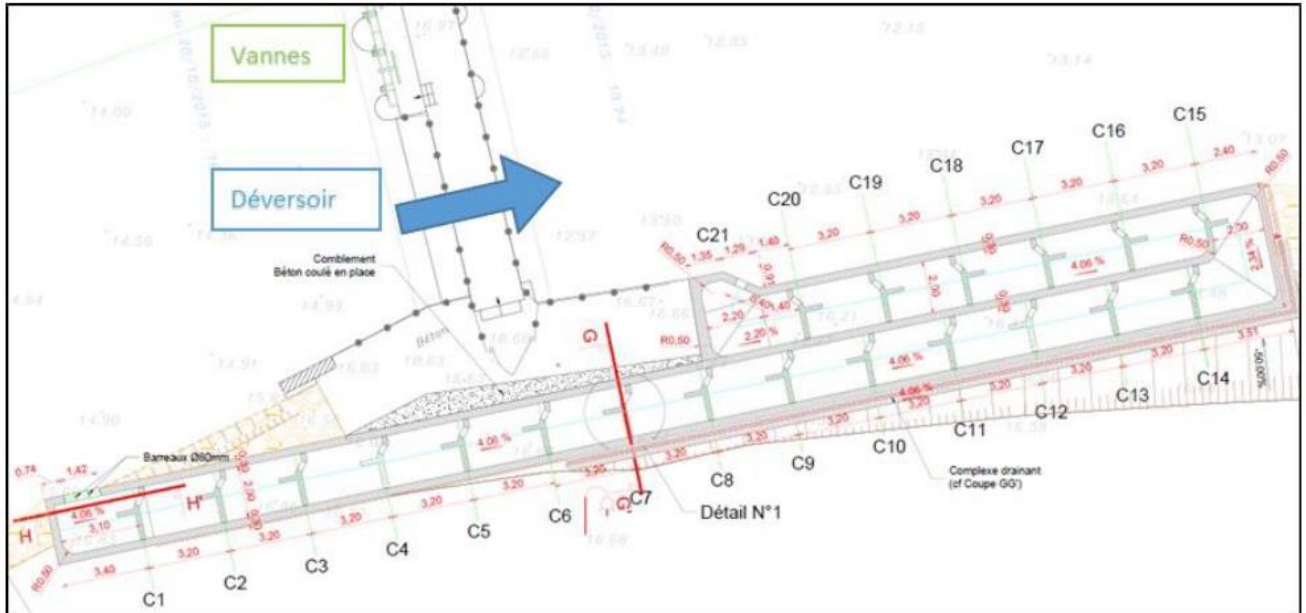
Vue en plan du scénario 2 – OH V (source : Suez Consulting pour ARIANEGROUP)
